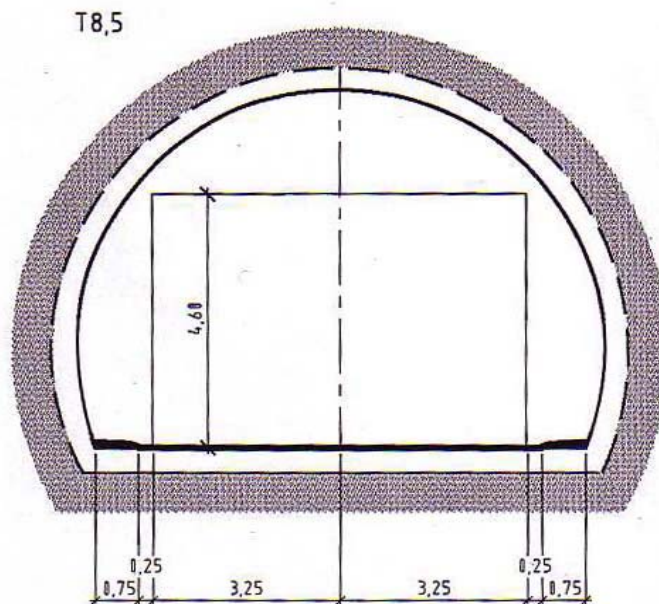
Section transversale typique pour un tunnel à un tube à trafic bidirectionnel
